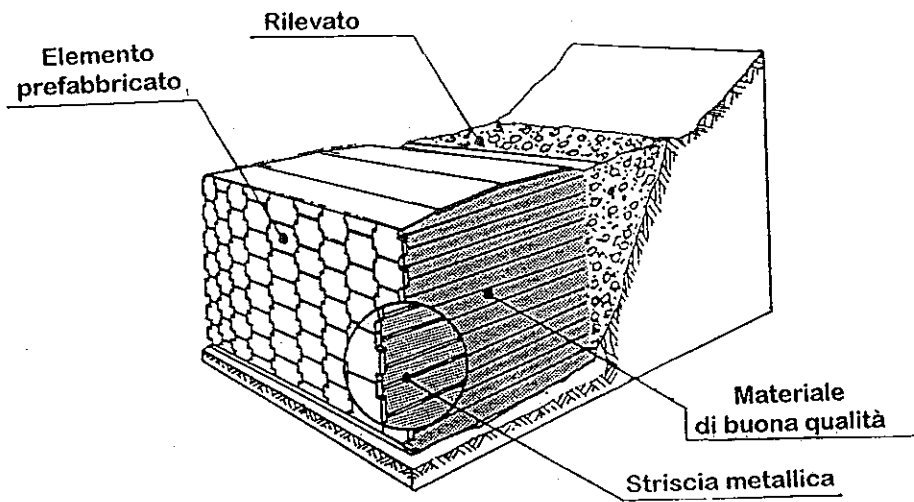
Muri in terra armata - Vista in sezione di un muro in terra armata.
